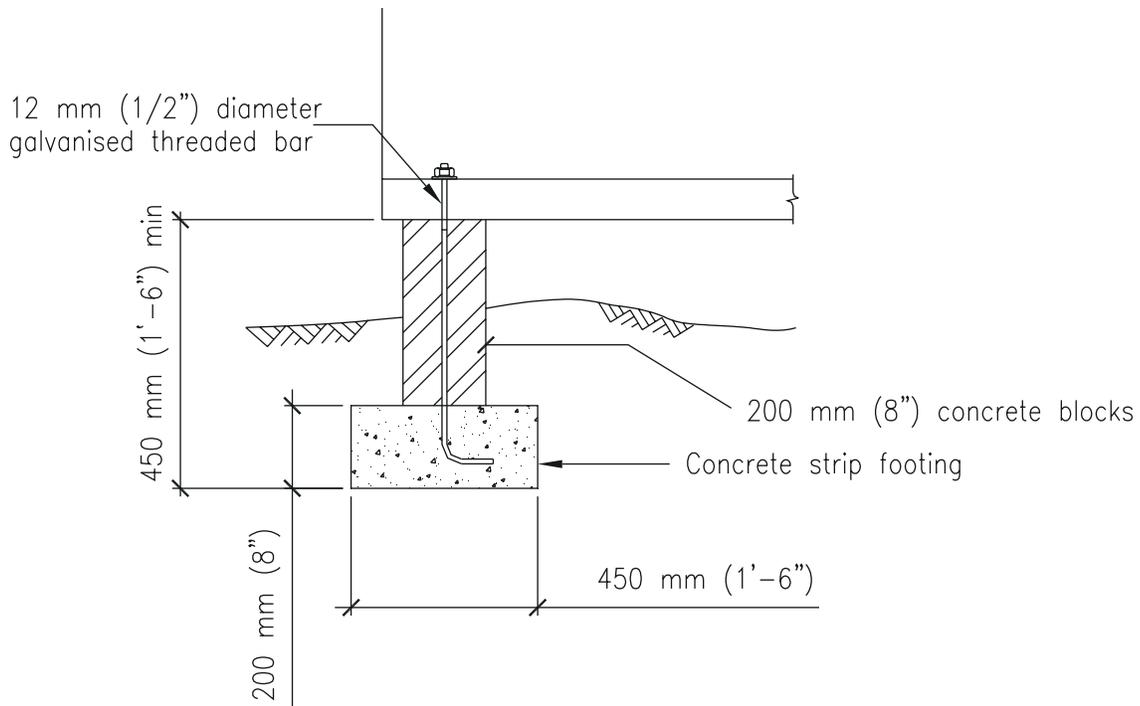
Semelle filante en béton et base en béton avec construction bois
